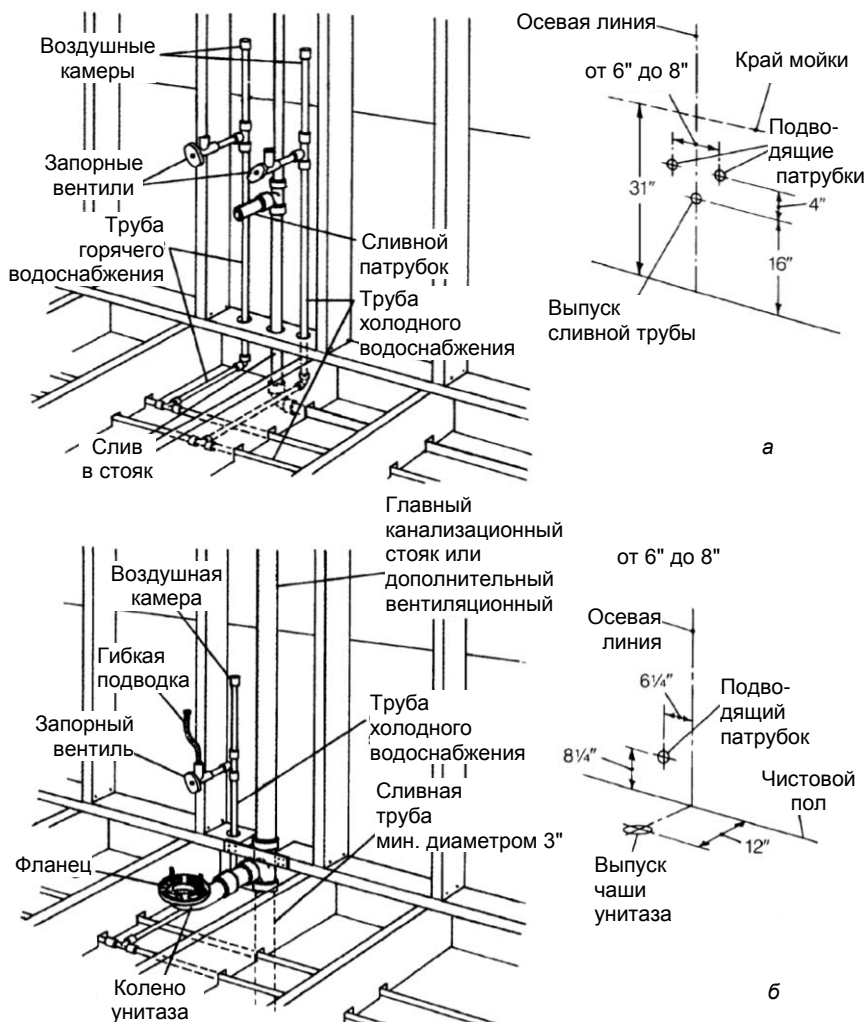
, а и б. Стандартные размеры труб для монтажа: раковины или мойки (а); унитаза (б)
